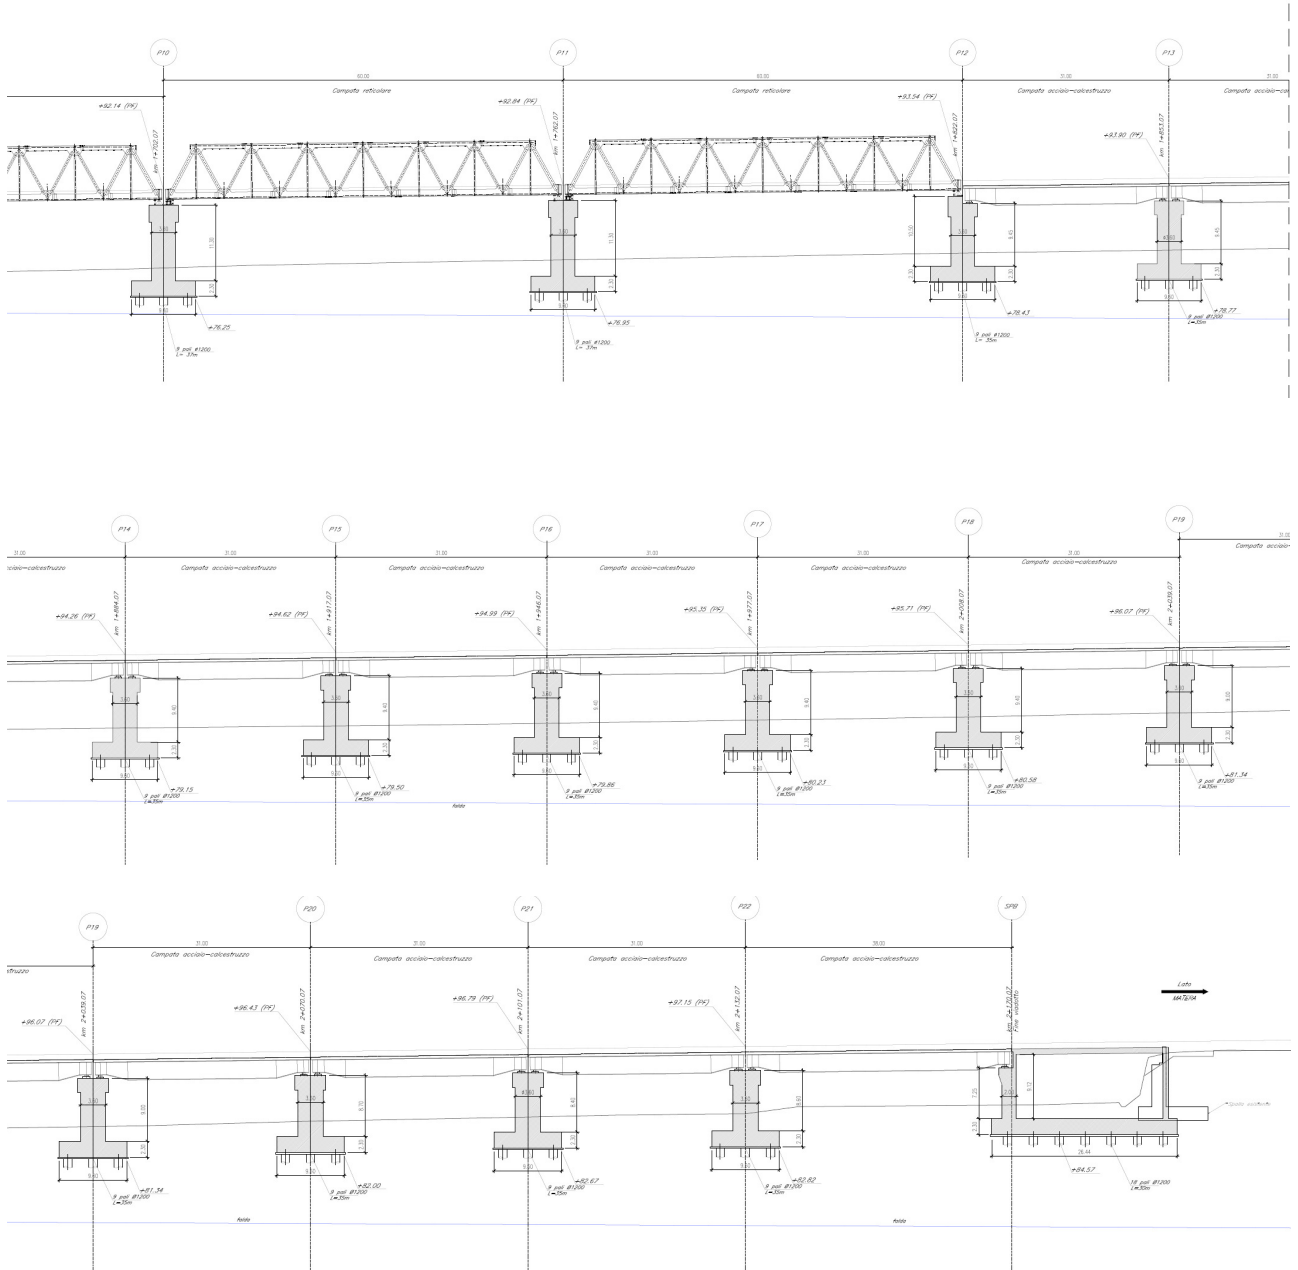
Sezione longitudinale viadotto VI13 Nuovo Basento
